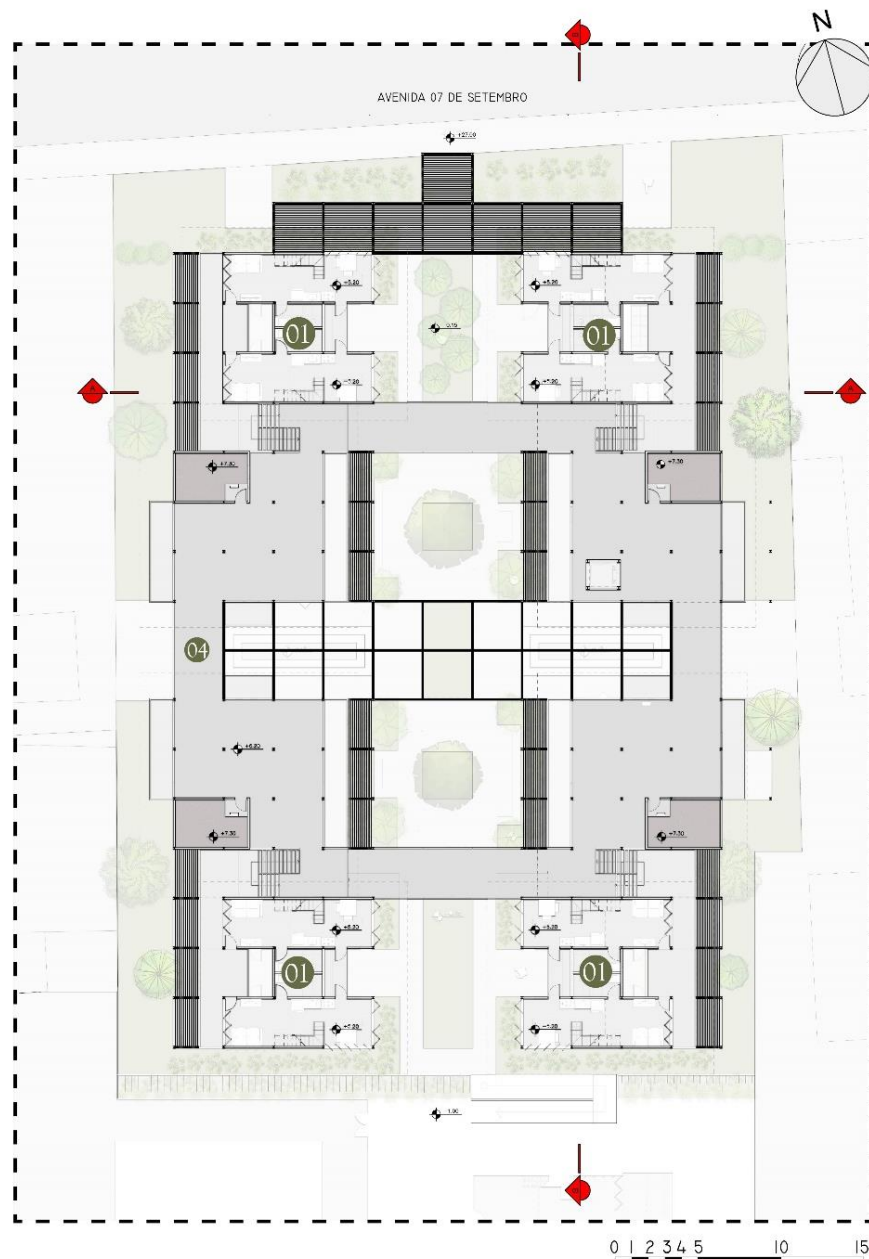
Planta Baixa Bloco A – Pav. 02. Fonte: Acervo do Autor.
